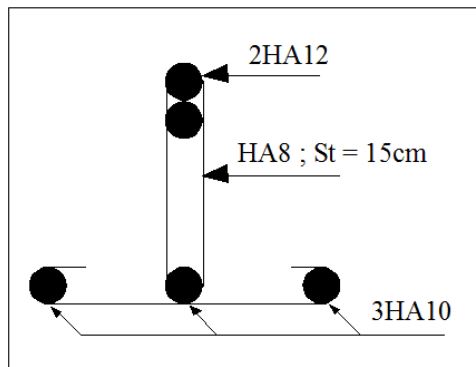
Schéma de ferrailage des nervures « plancher terrasse »
